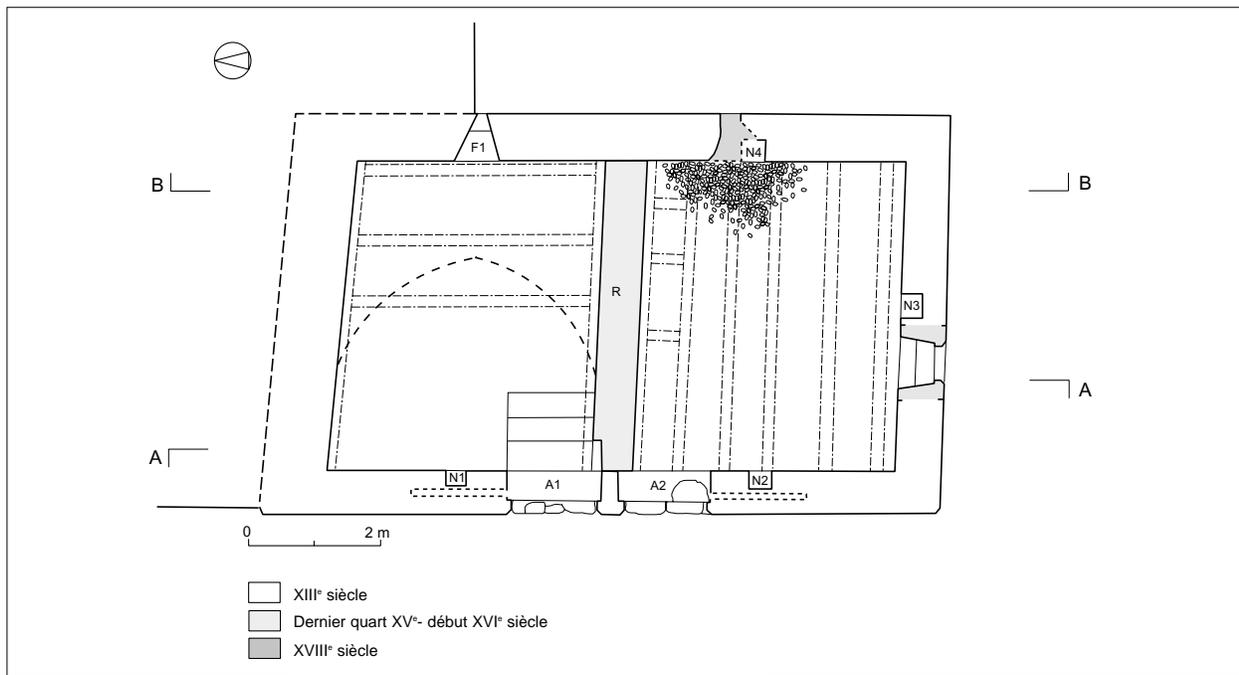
MAISONS JUMELLES N° 1. Plan du rez-de-chaussée. Relevé V. Rousset, 2001.
